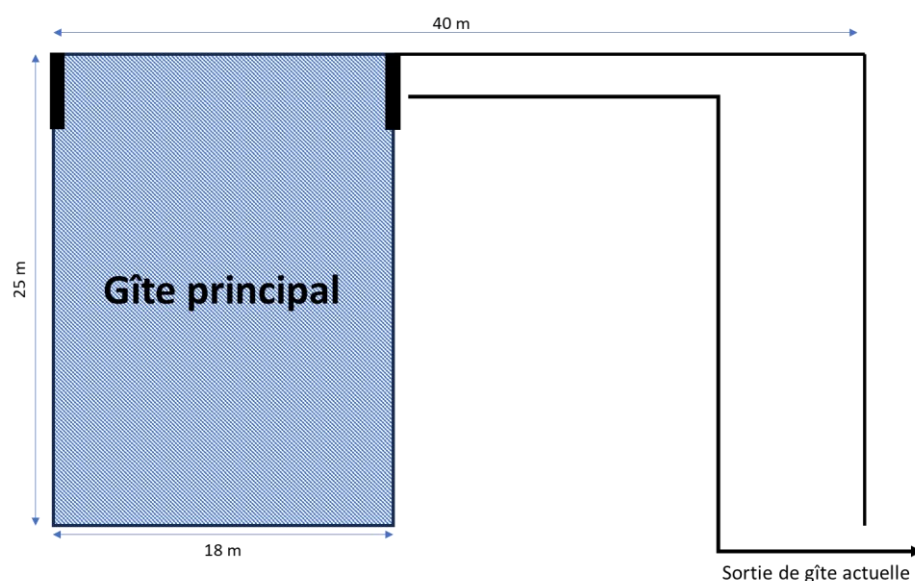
Plan actuel du bâtiment central (Alisea 2026)
